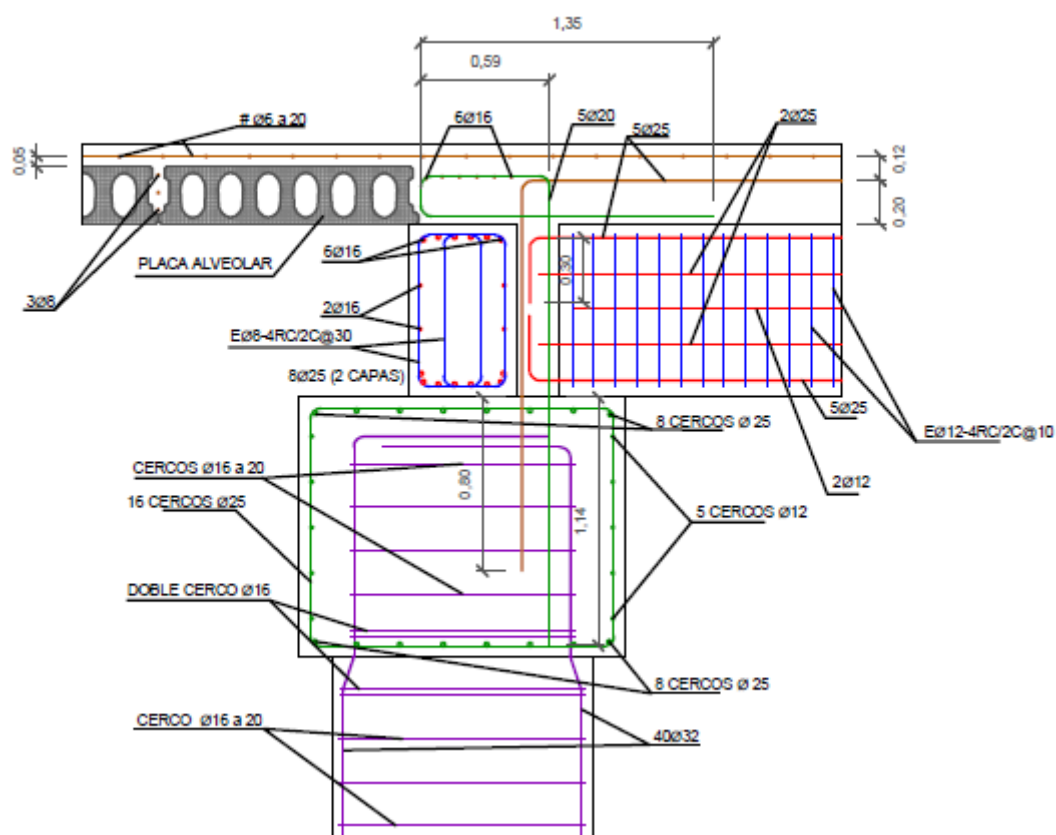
Armadura de junta plataforma, juntas entre viga V y vigas III.2 en brazos de carga.
